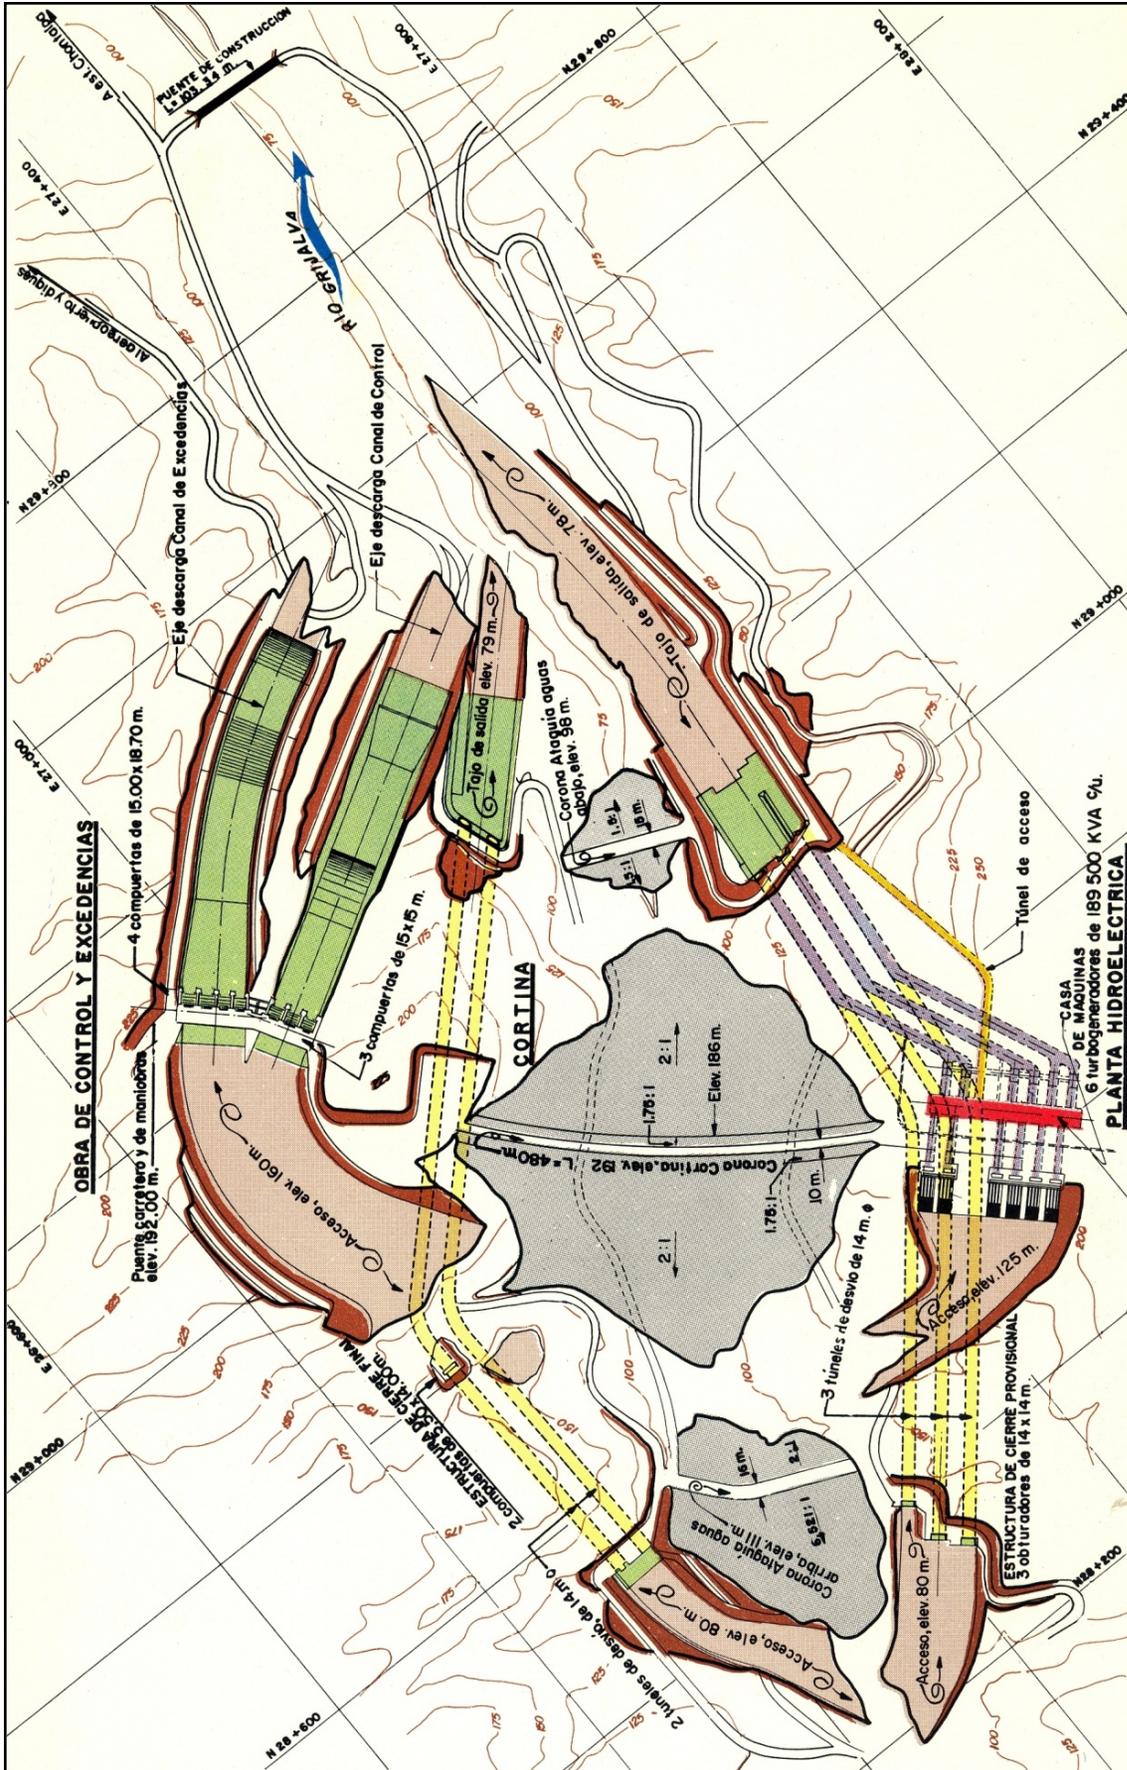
Planta General de la presa Netzahualcóyotl “Malpasos”.
